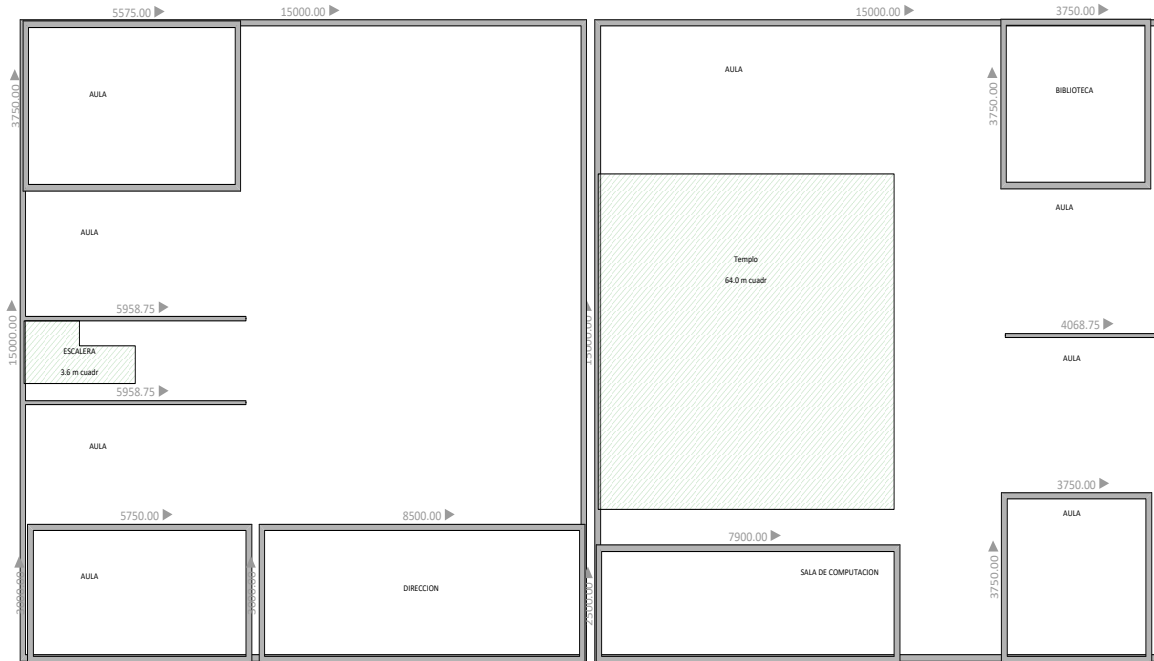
Plano de aulas, oficinas y templo en planta baja del edificio
